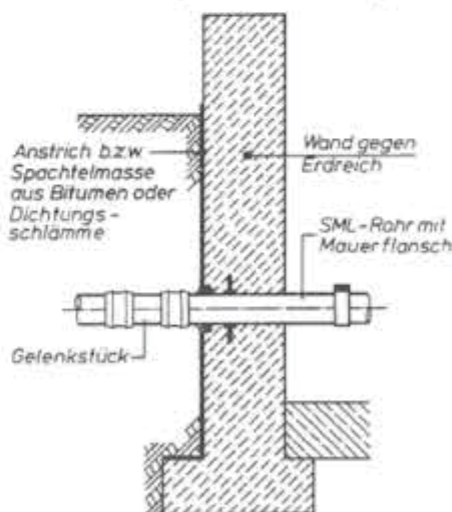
Gelenkig ausgeführter Anschluss einer Grundleitung nach Austritt aus dem Gebäude
